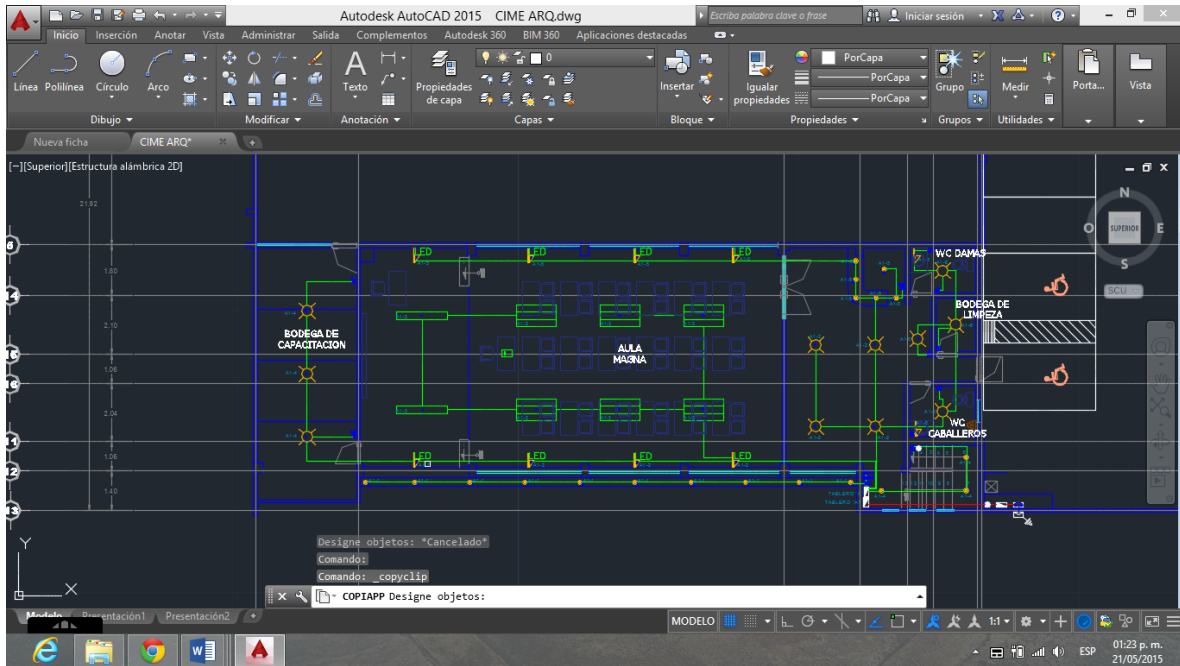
Plano de la primera planta del colegio salón de entrenamiento, bodega del salón y entrada al salón de evento instalaciones eléctricas del área.
